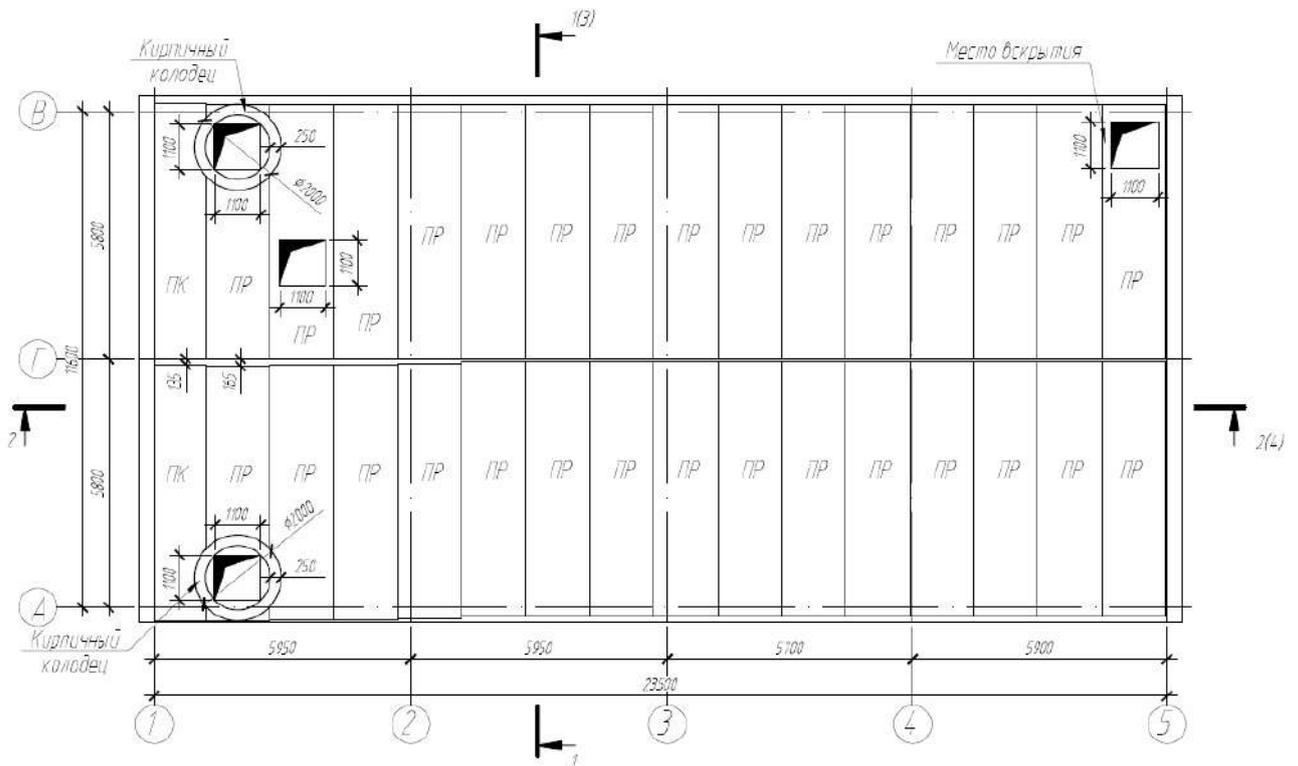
Схема расположения конструкций покрытия резервуара
